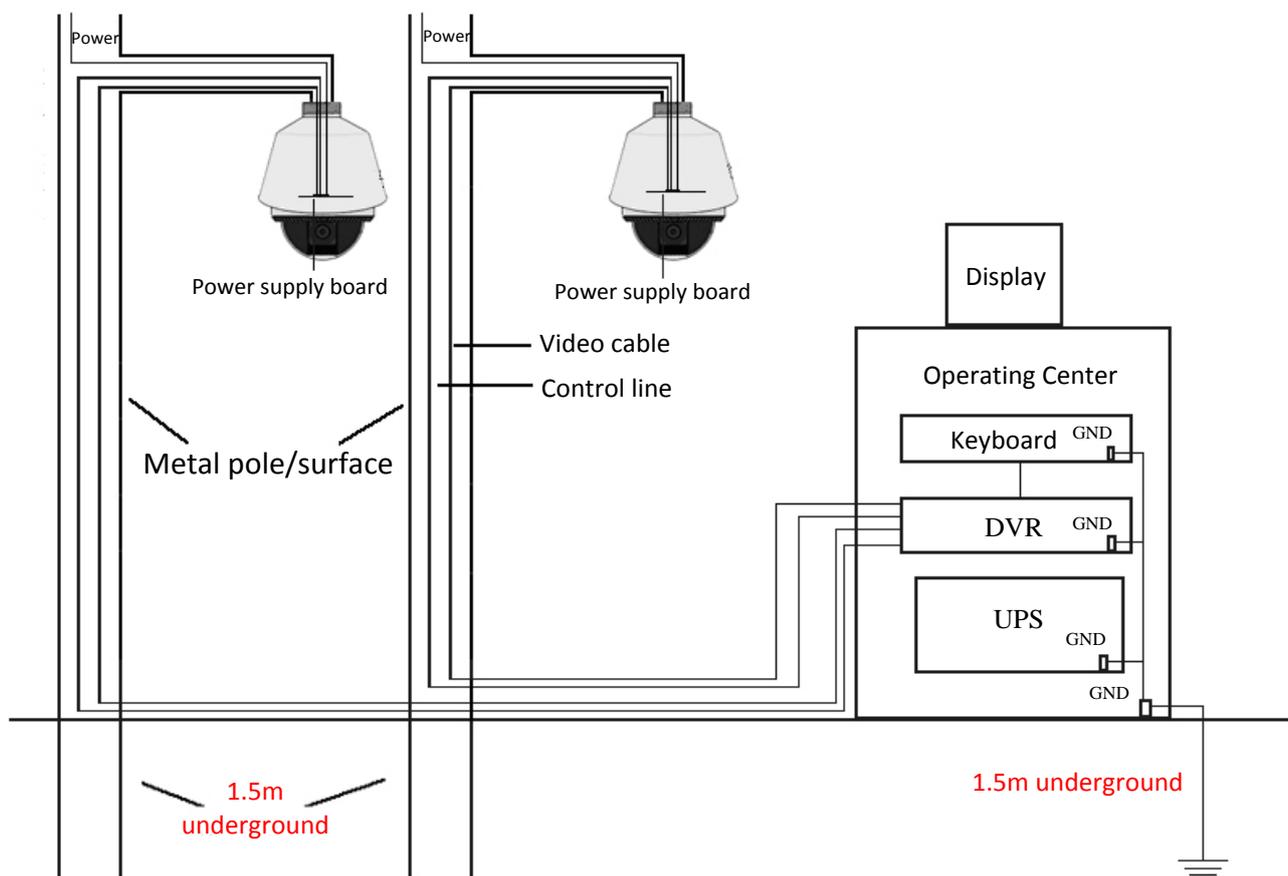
Mise à la terre d'une installation sur poteau métallique
